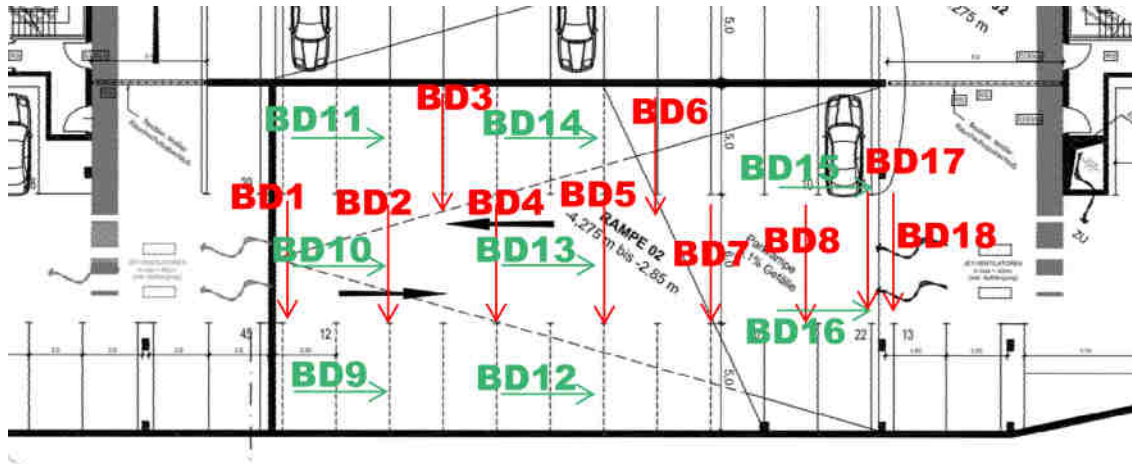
erste Rampe mit Lage der Messstellen zur Betondeckung
